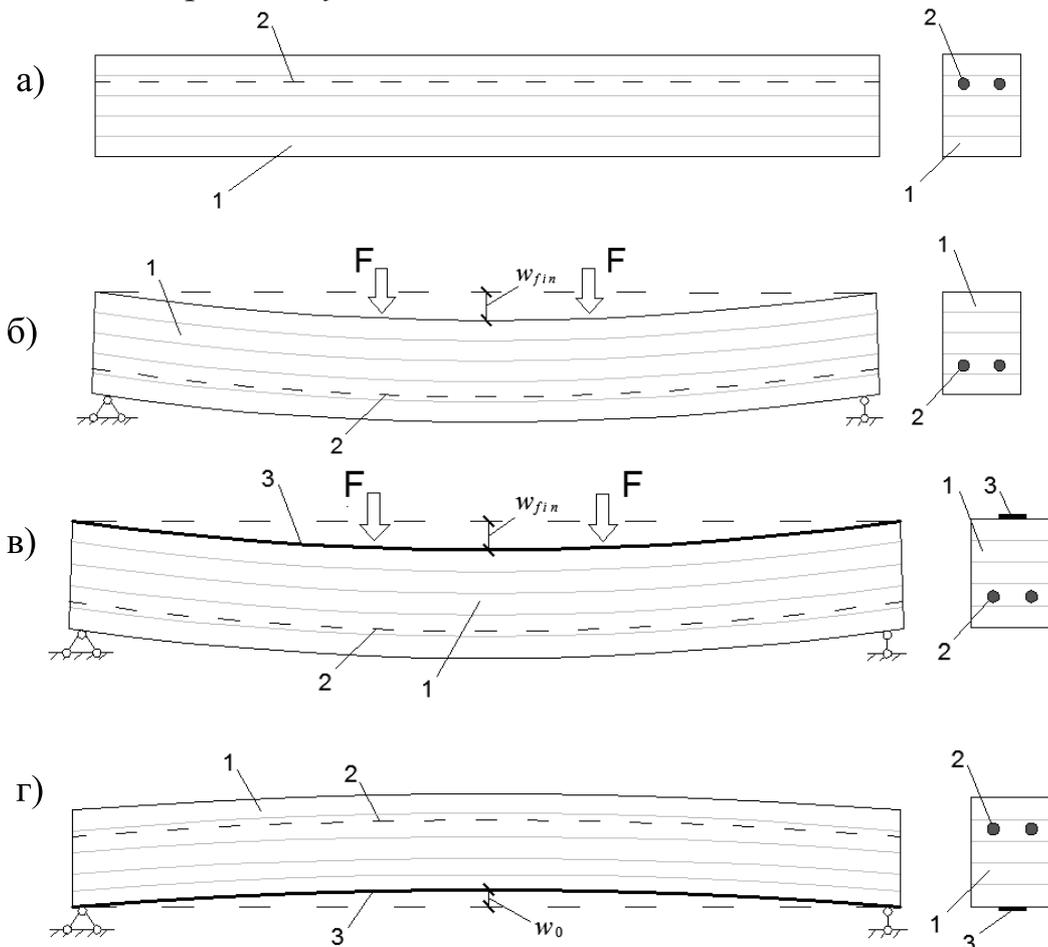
Розрахункова схема при випробуванні на згин попередньо-напруженої дерев'яної балки із комбінованим армуванням
